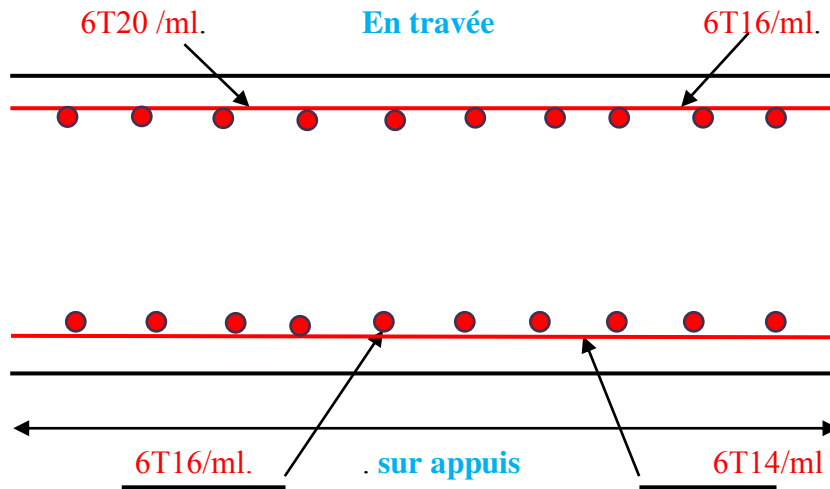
ferrailage de la dalle du radier (Travée + appuie).
